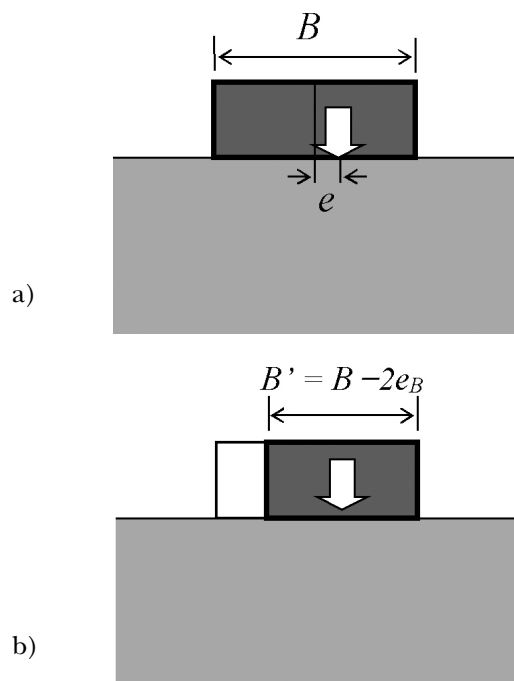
Concetto di larghezza ridotta di una fondazione nastriforme in caso di carico eccentrico: a) fondazione reale con forza eccentrica; b) fondazione di larghezza ridotta con forza verticale centrata.
